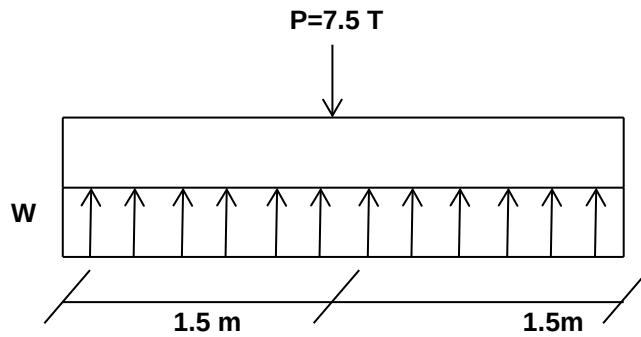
Acción de la carga viva sobre la losa de aproximación.
